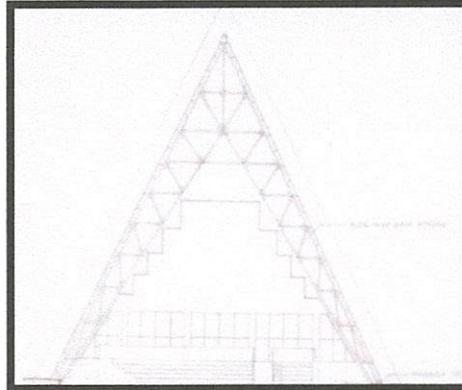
Jenis Bentuk Kolom dan Balok
